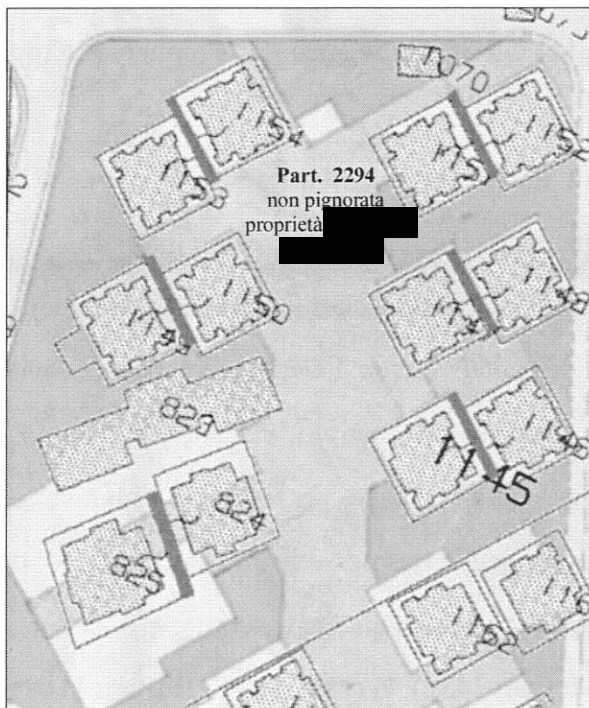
e 35 sovrapposizioni tra planimetria di progetto, planimetria catastale e tipo mappale.
